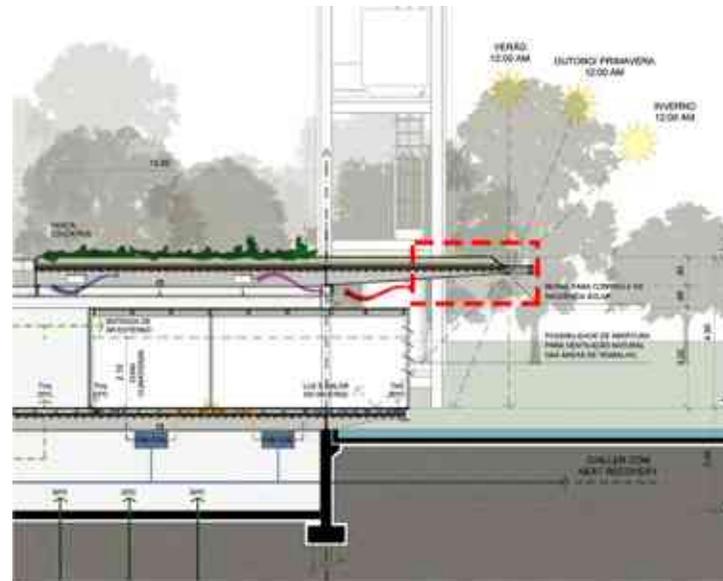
Corte do beiral na fachada Norte (tracejado vermelho). Fonte: SILVA, T. C. da; *et al.*, 2020 (Adaptada).
